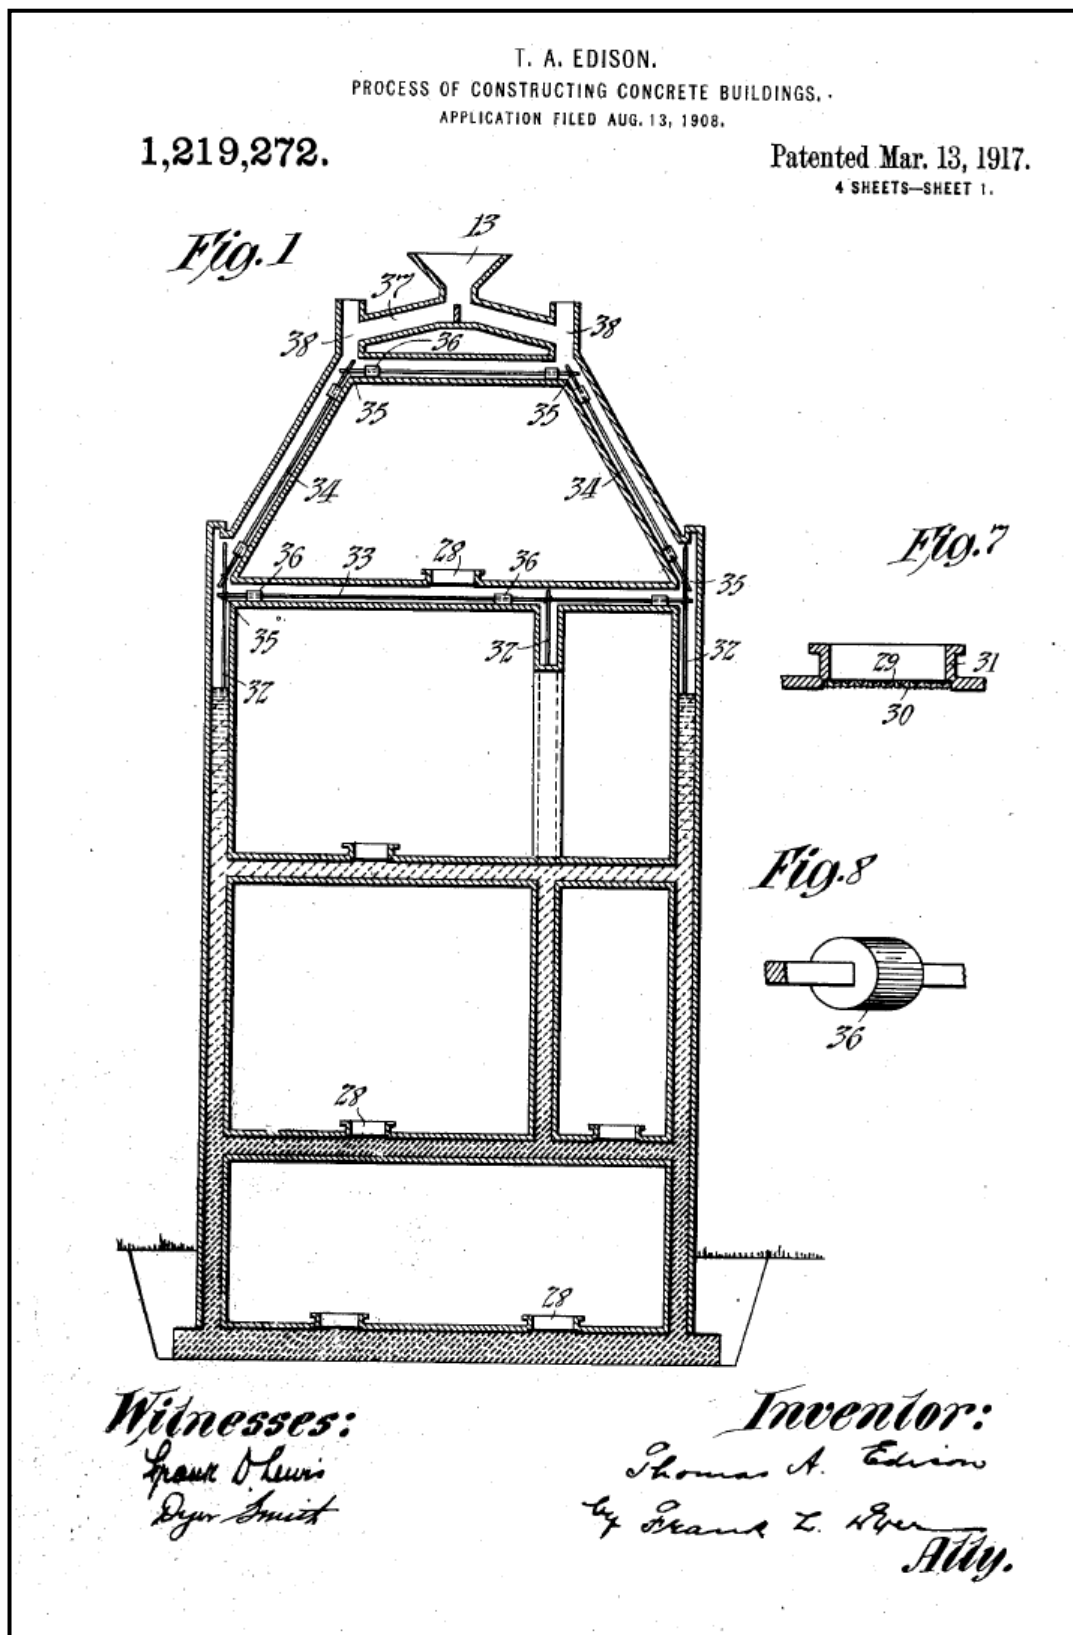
Proceso de construcción de edificios de hormigón. Thomas Edison.
